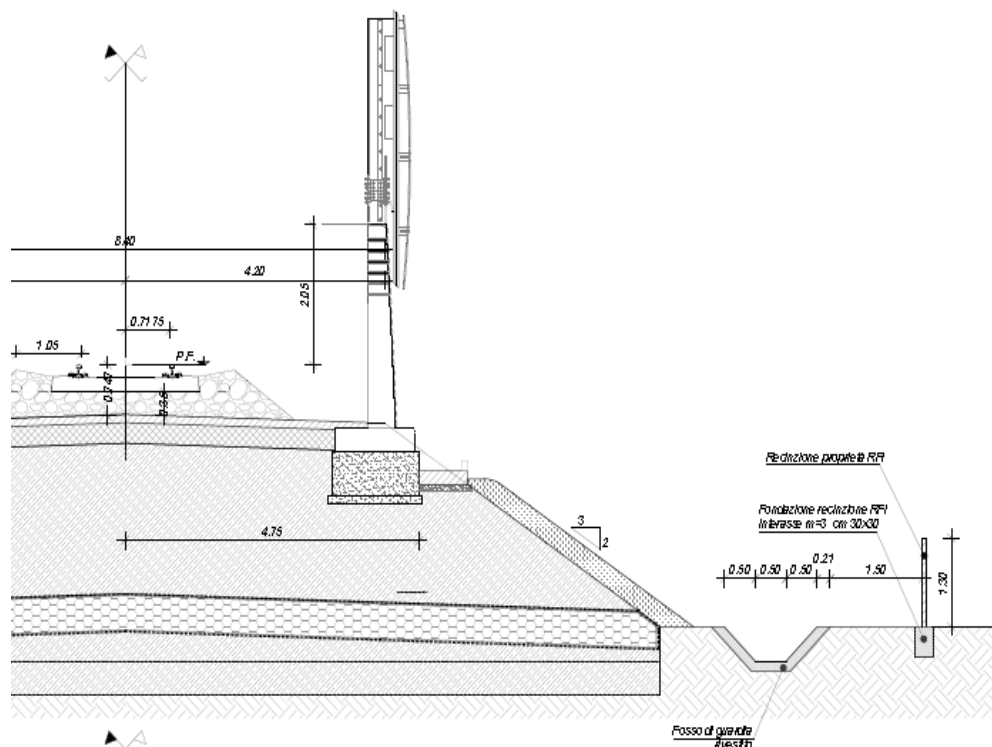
Dettaglio alla base del rilevato ferroviario senza pista di servizio
